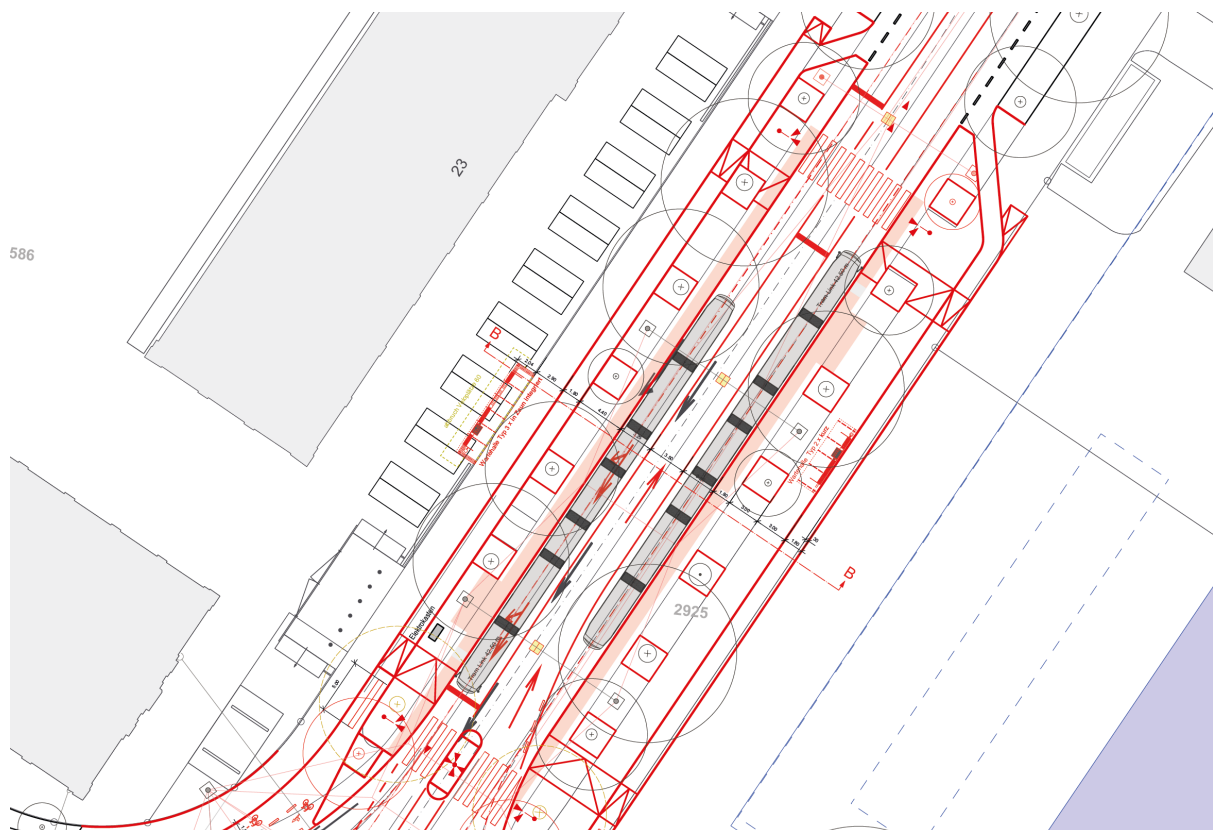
Haltestellenbereich Papiermühlestrasse, Ausschnitt Situationsplan
